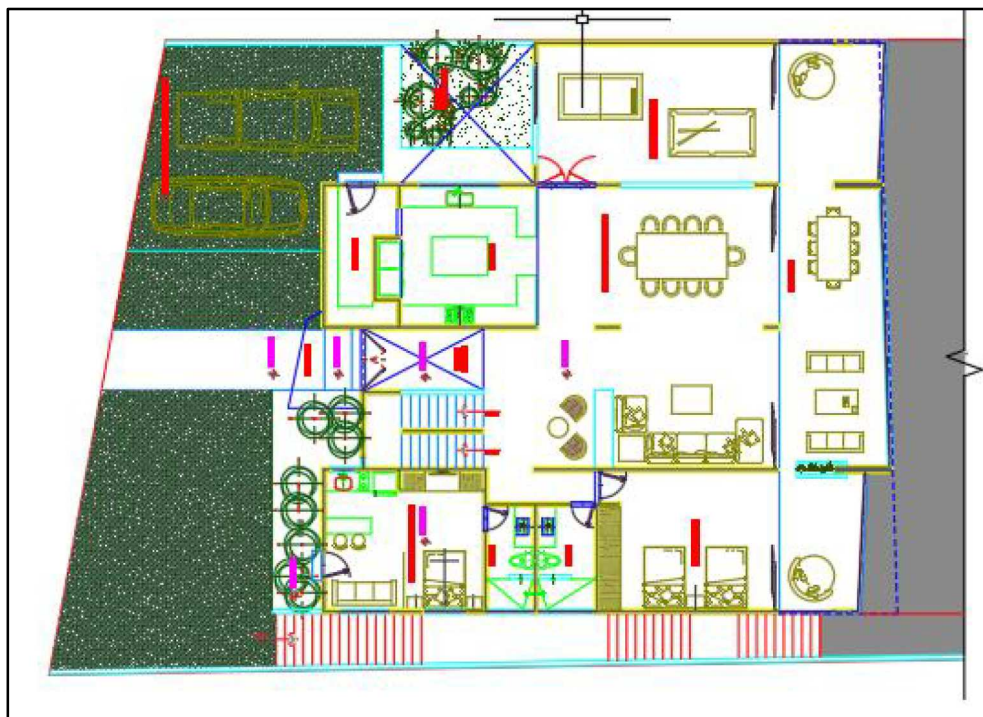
Distribución de áreas de la planta baja a nivel de calle.
